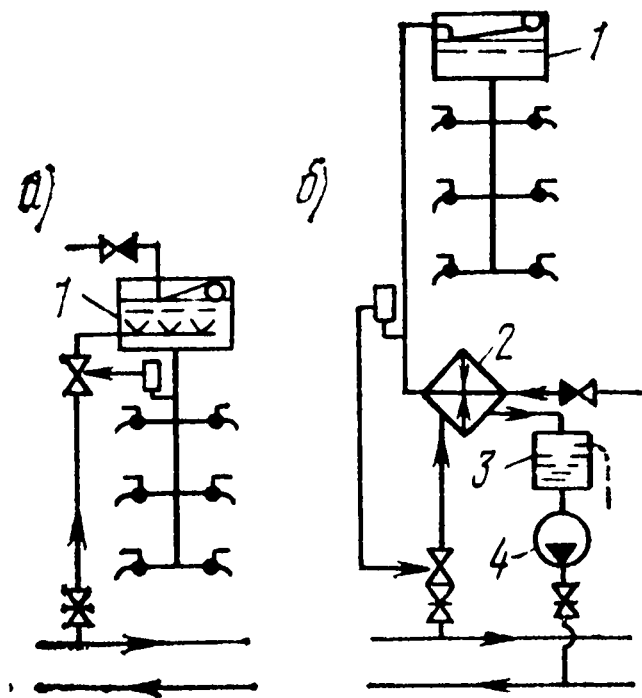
Схемы присоединения систем горячего водоснабжения к паровым тепловым сетям
